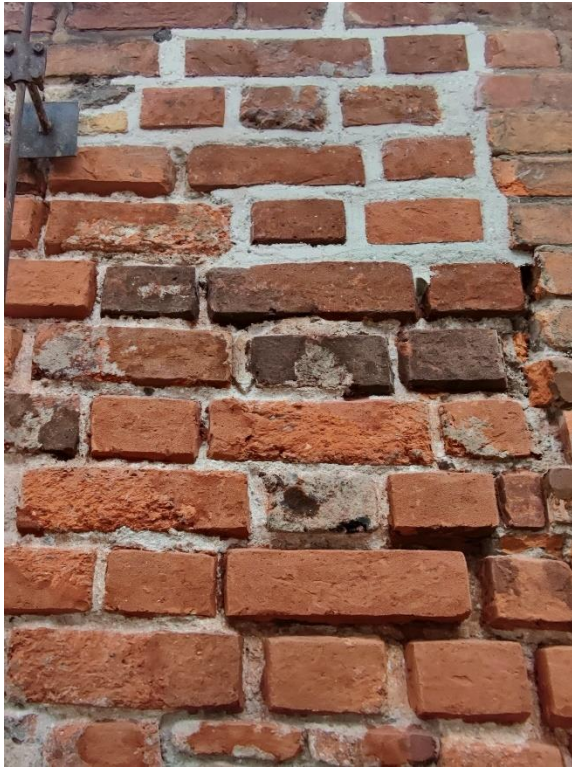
Iniekcje w celu wypełnienia pustych przestrzeni w murze
